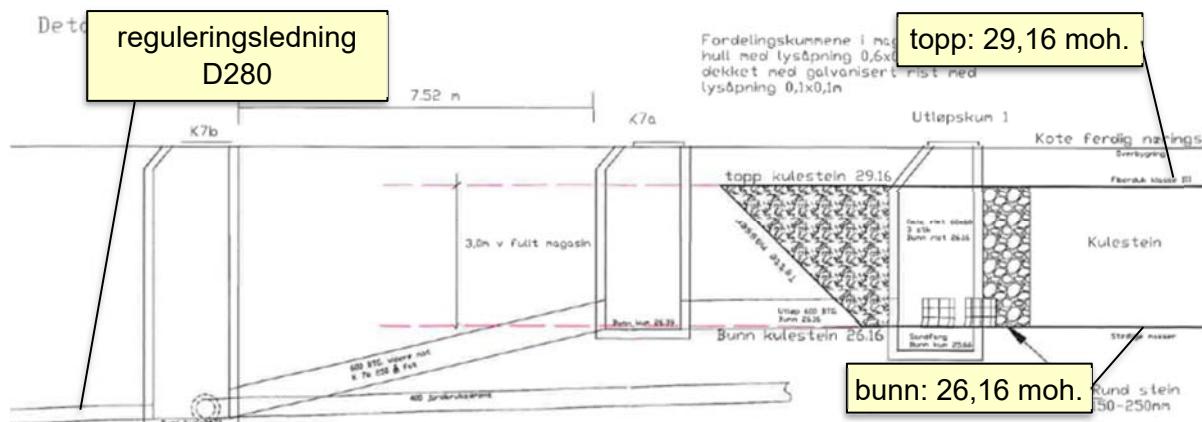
Drenering av laveste punkt i undergangen ved Brøytvegen
